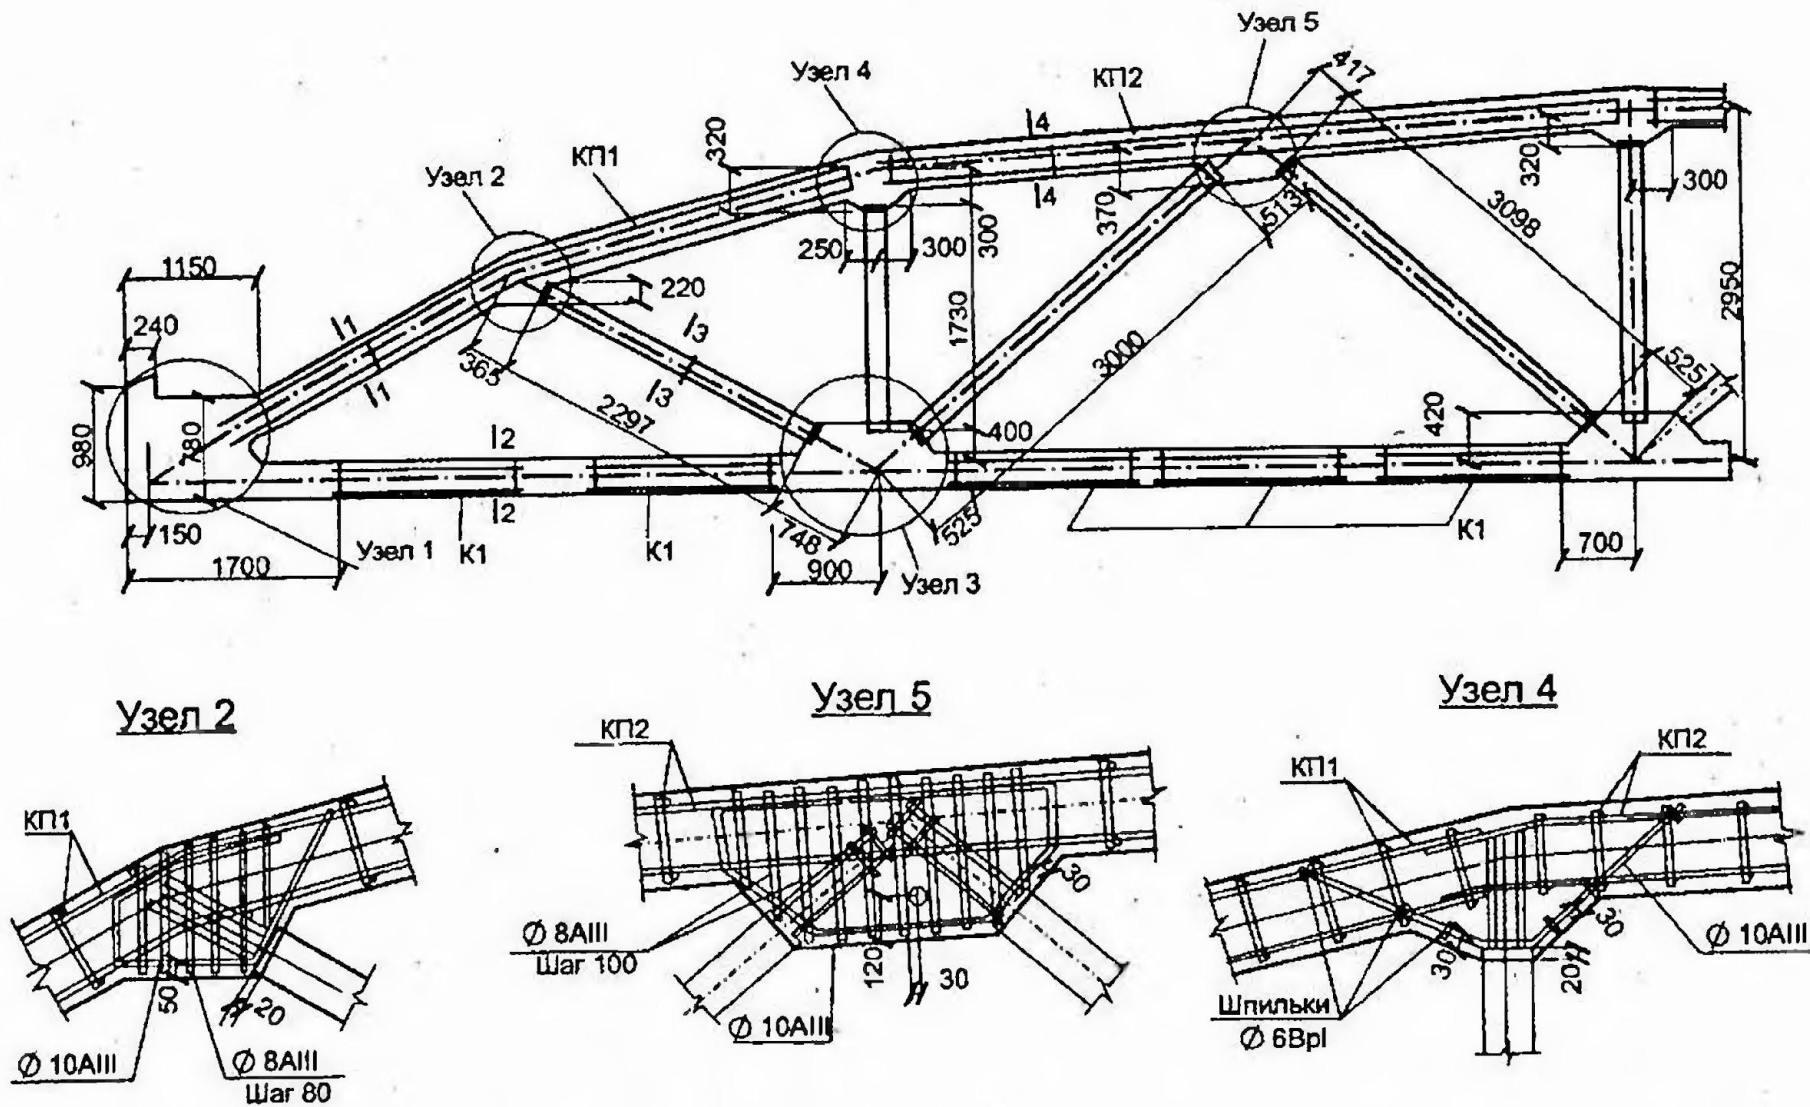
Армирование фермы (схема расположения каркасов, армирование узлов)
